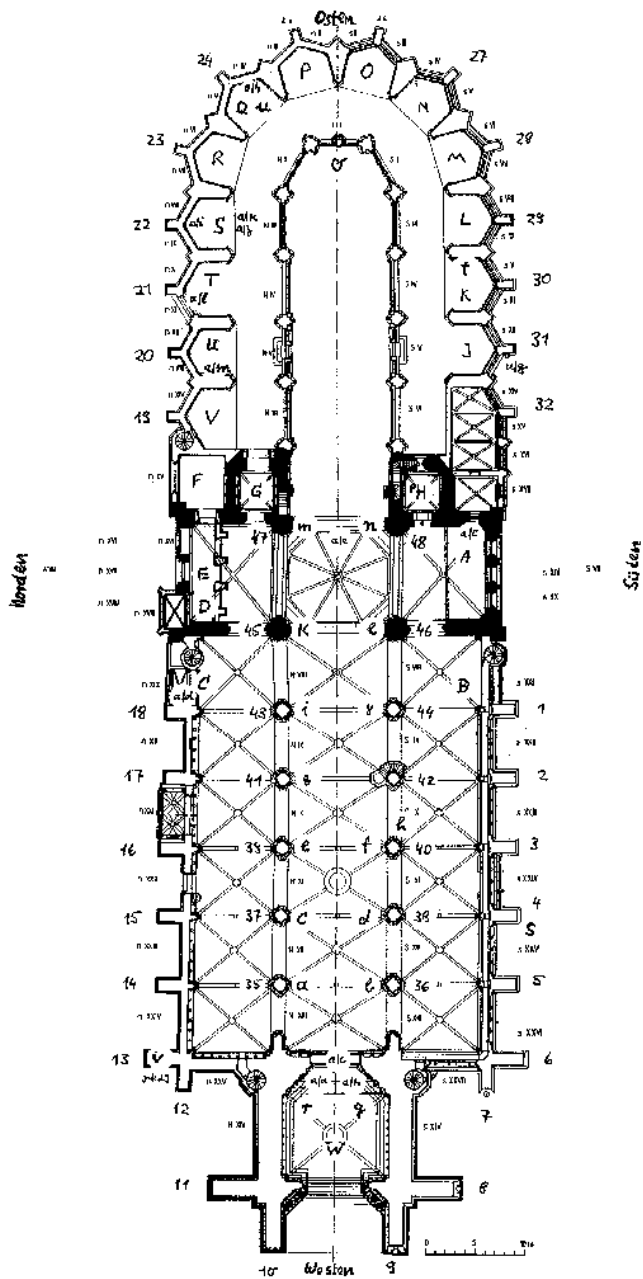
Grundriss des Münsters und Lageangaben zu den im Text erwähnten Standorten
